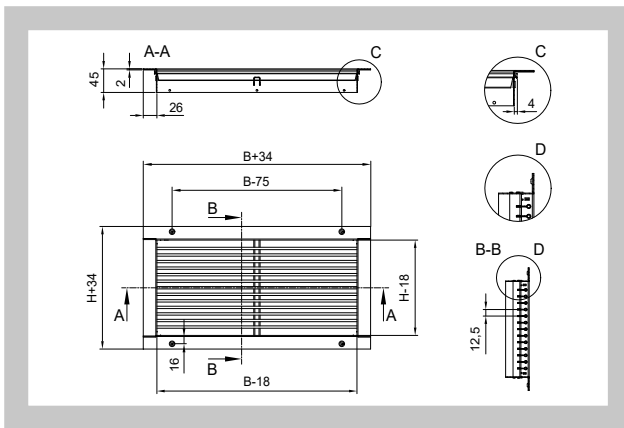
Feste Lamellen - Lamellenabstand 12,5 mm B > 600 mm
